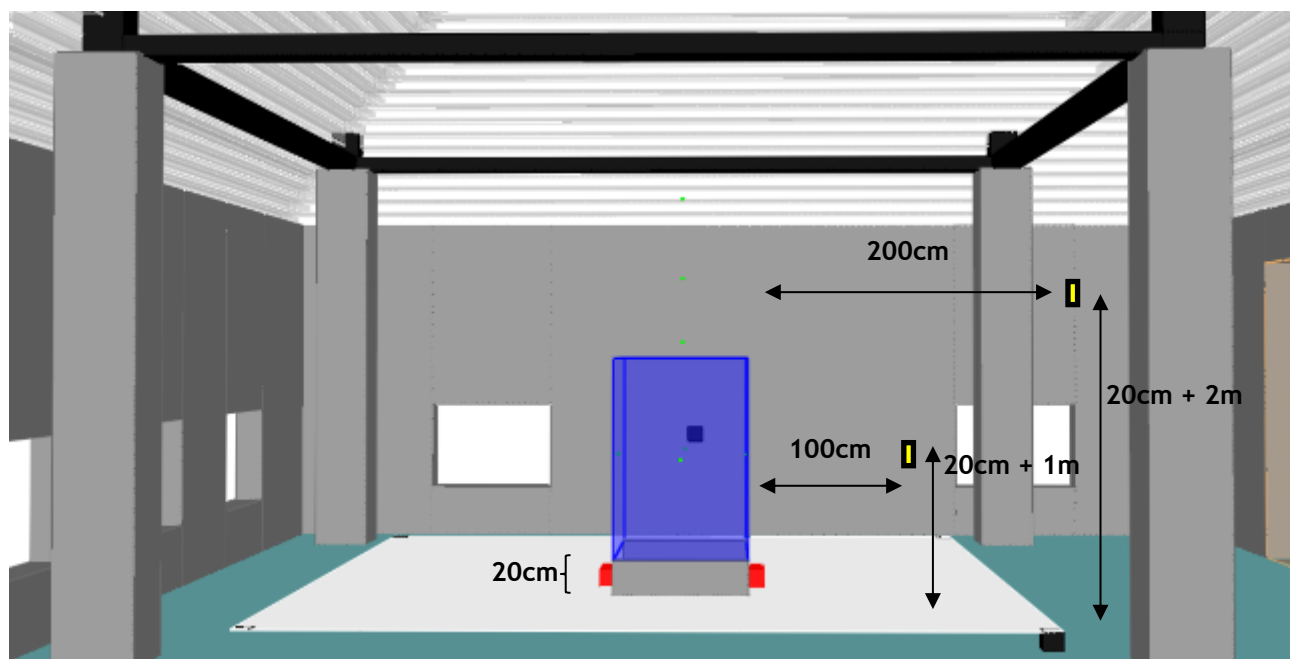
Plan d'instrumentation depuis la face Est (entrée depuis l'extérieur)
